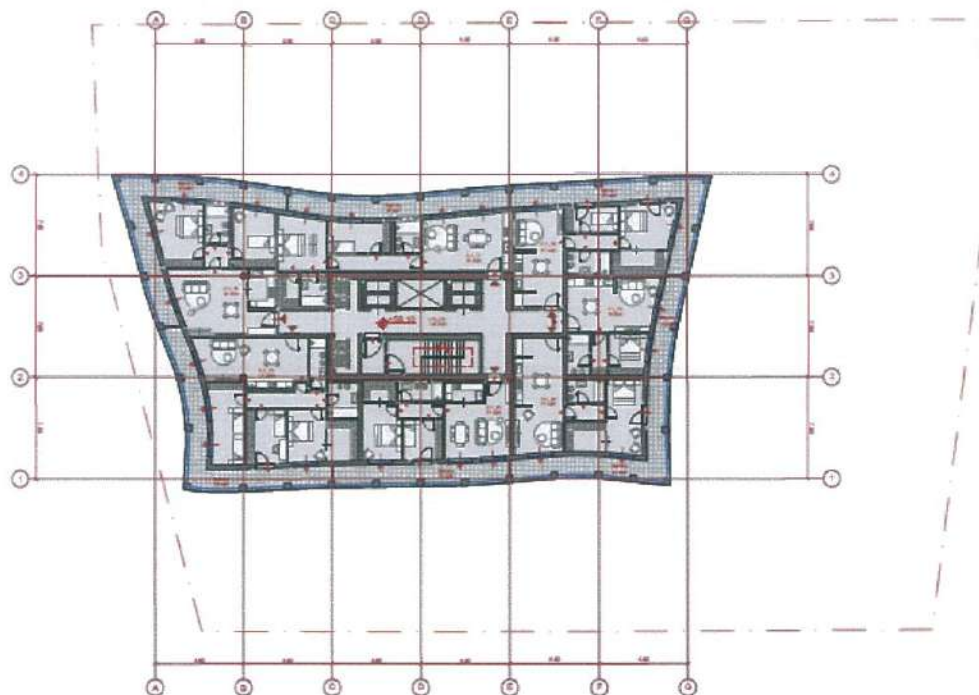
Planimetria e katit 14, në kuotën +56.10 SIP 930 m²
